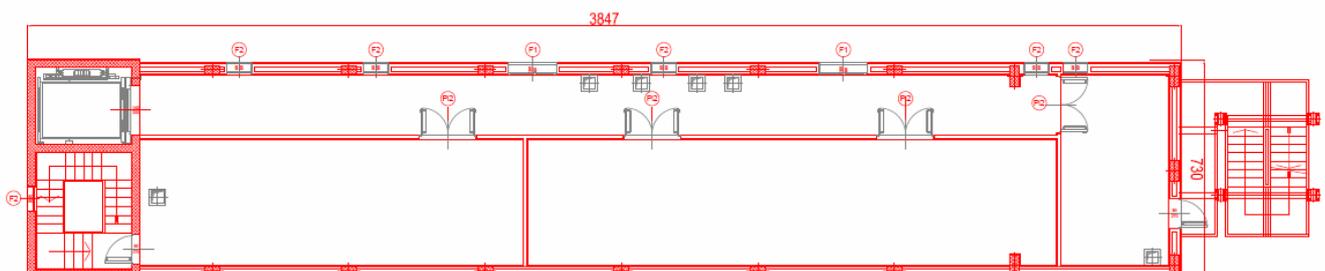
Localizzazione del fabbricato nel Progetto approvato (in blu) e nel Progetto in variante (in rosso).
